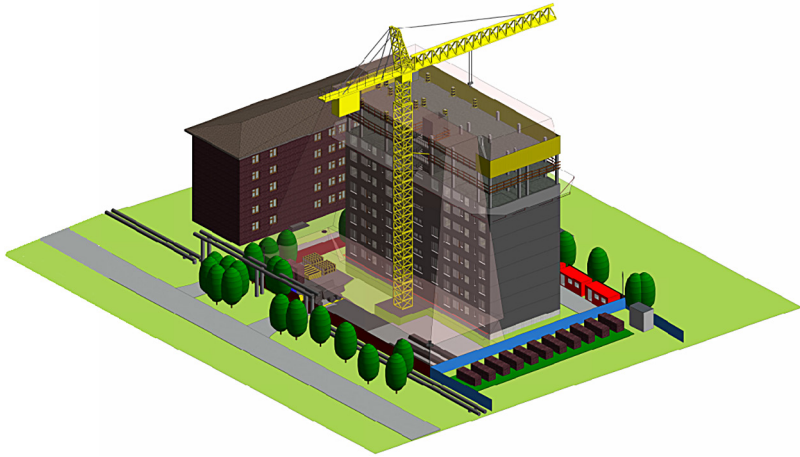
Скрин из программы Revit 4D-модели строительной площадки на стадии возведения каркаса здания
